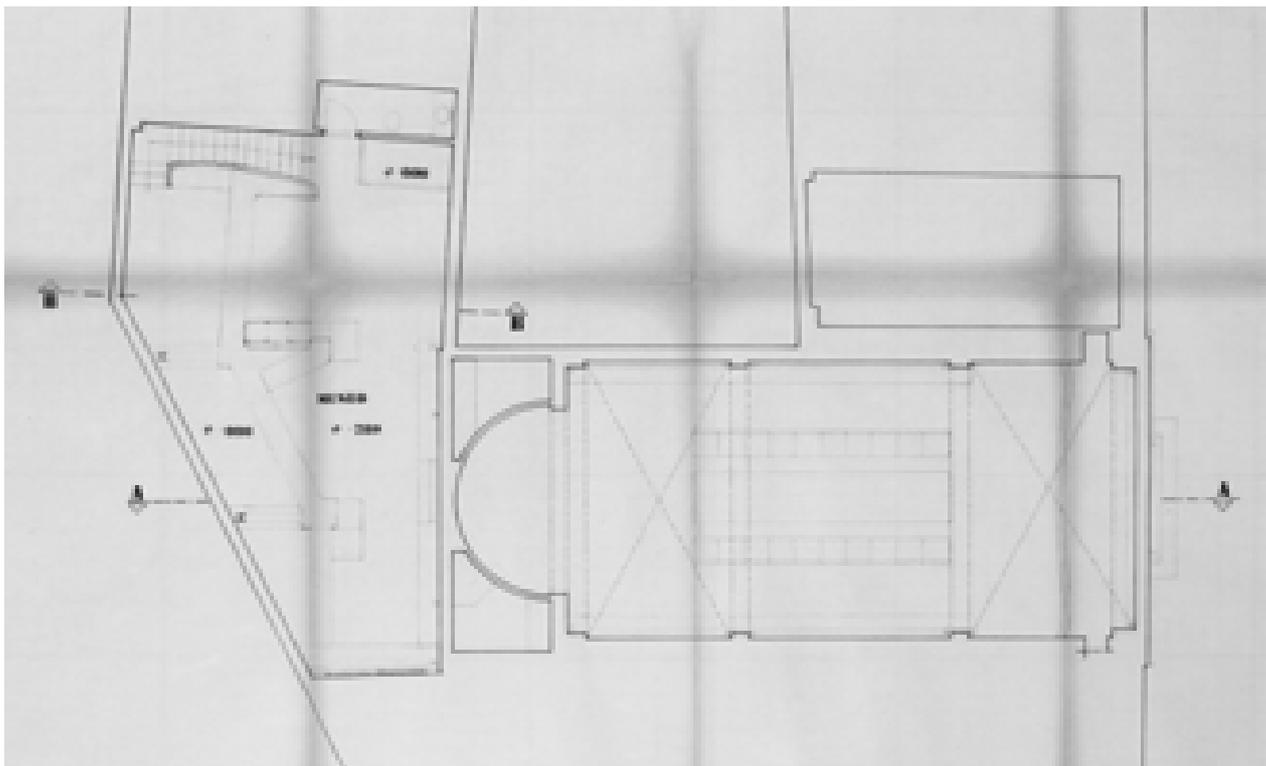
Pianta doppio volume – Stato di progetto – 24/02/1981 (AABS-94.048)
